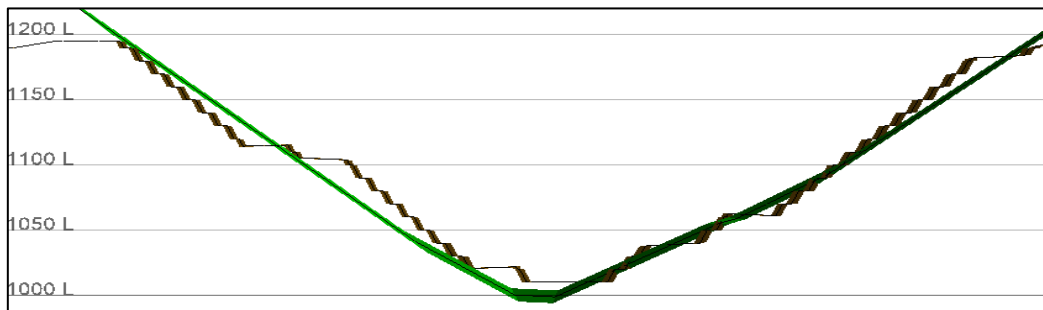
LGMM1Y Fase 6 - Vista en sección - Corte secundario S-E
